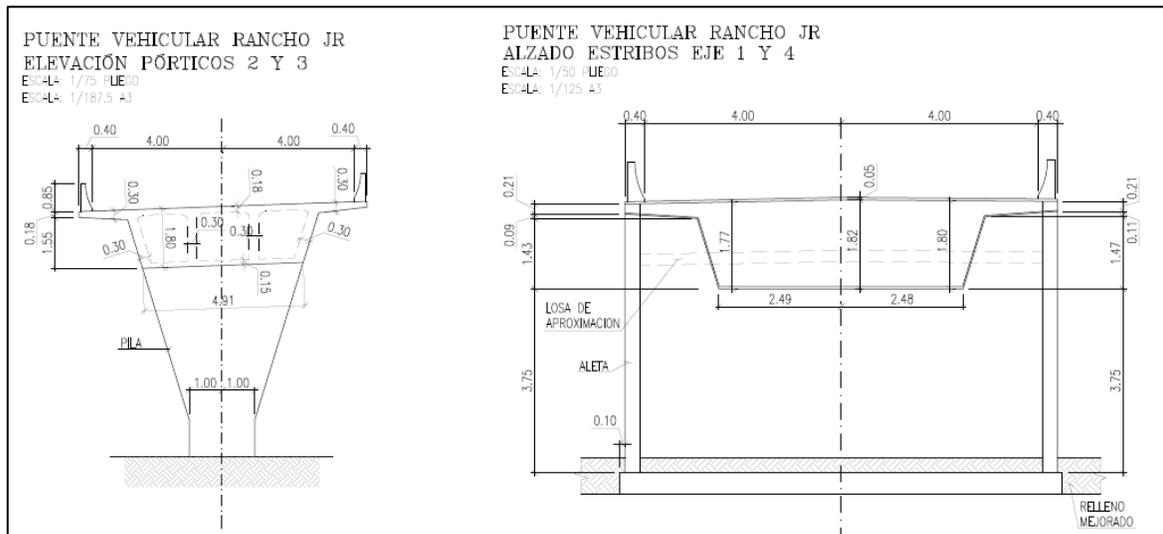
Vista General Rancho JR. Estribos Y Pilas
